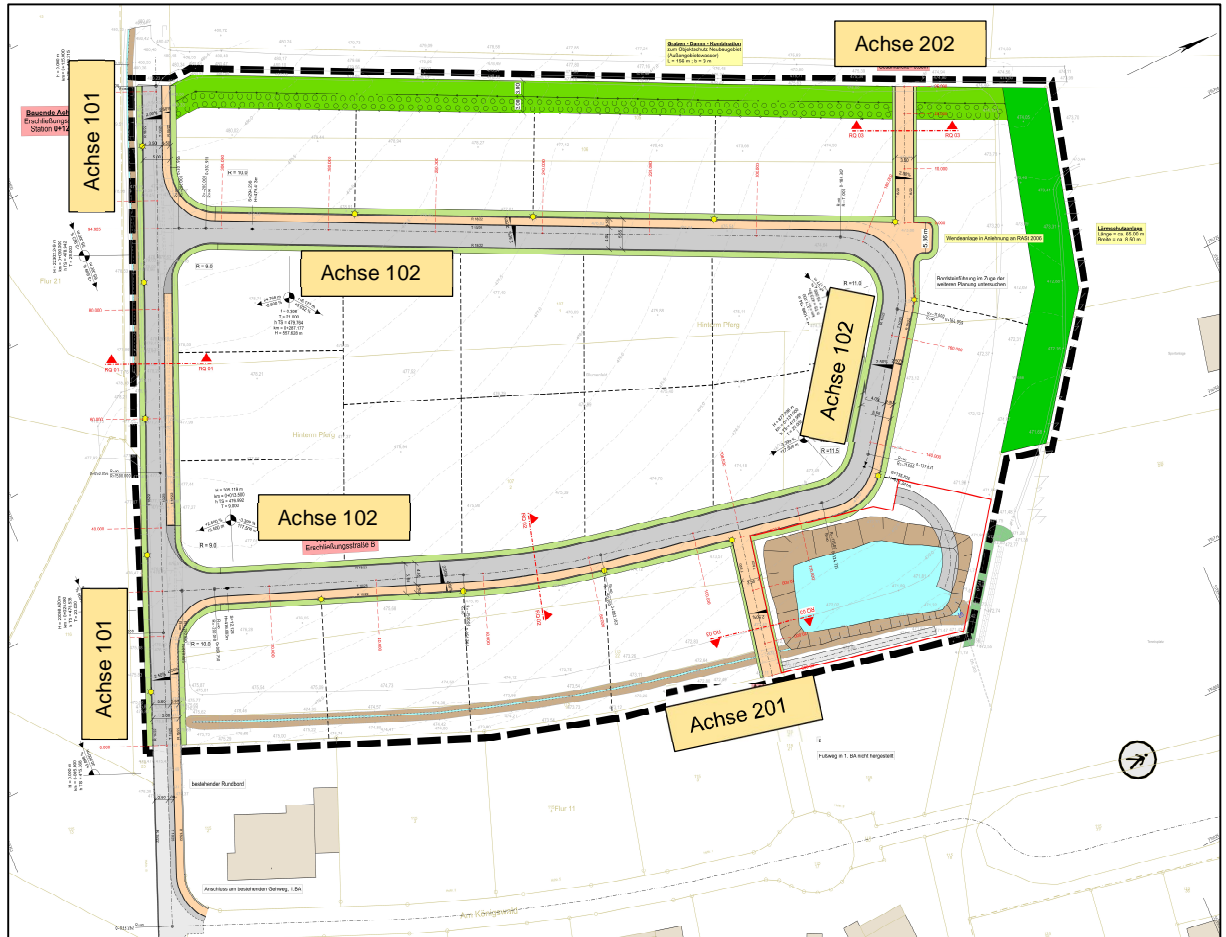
Lageplan Verkehrsanlagen; dient der Orientierung/ Übersicht
